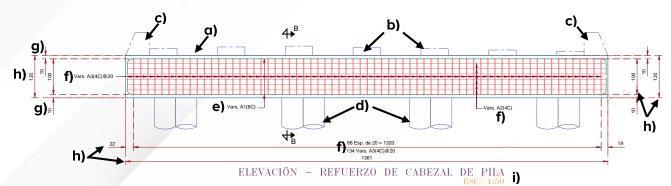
Ejemplo de elevación del refuerzo de cabezal de pila
